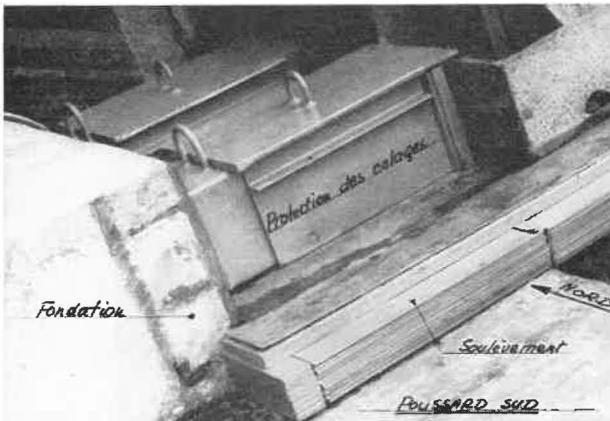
Vue des boîtiers de protection placés sur les calages servant à maintenir le pied du poussard sur le plan incliné de la fondation. On remarque également les 100 mm d'épaisseurs placées en dessous du pied.
